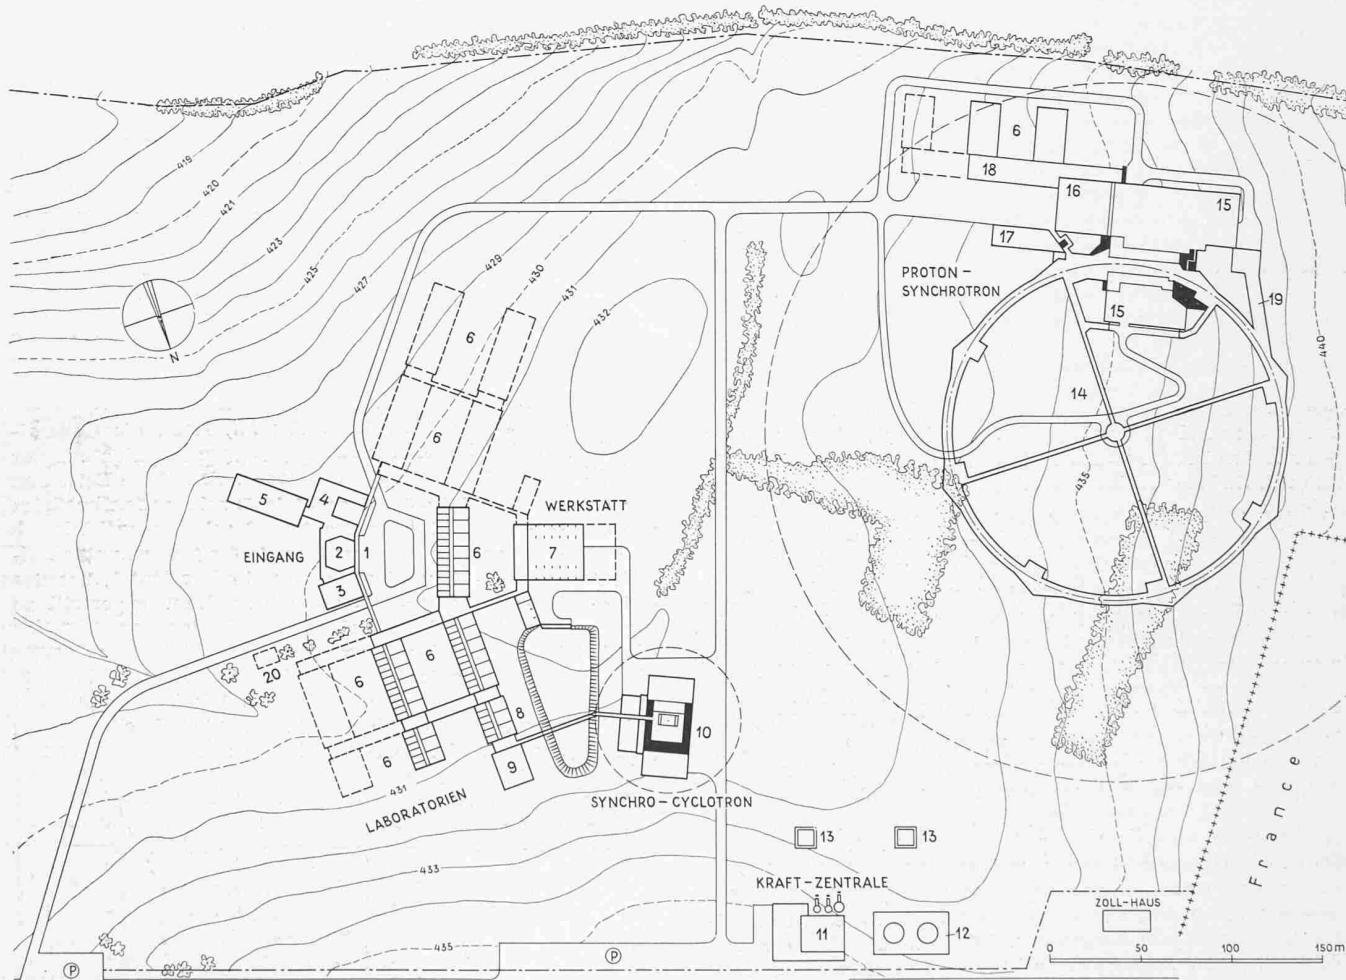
CERN-Laboratorien, Lageplan 1:4000
